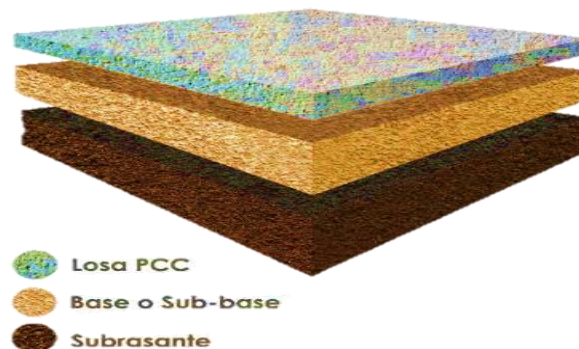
Estructura de un pavimento rígido. Fuente: Luis G. Loría Salazar.
